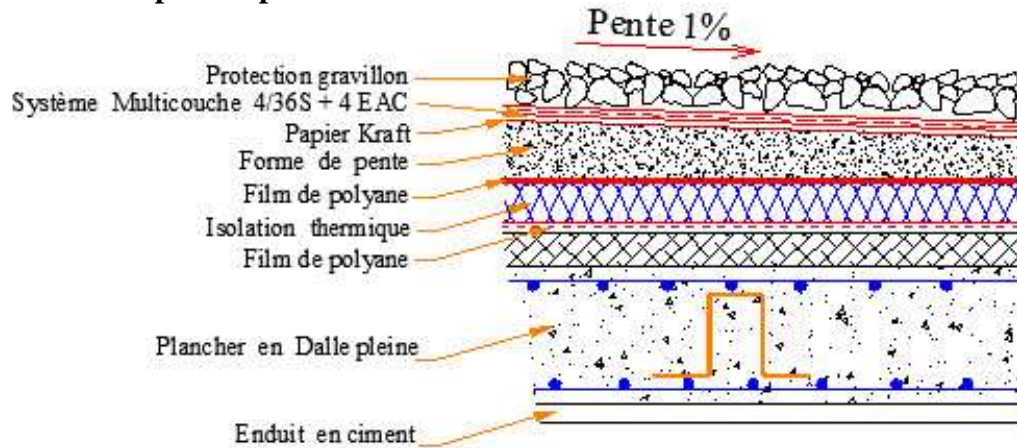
Coupe verticale du plancher terrasse inaccessible (Dalle pleine)
